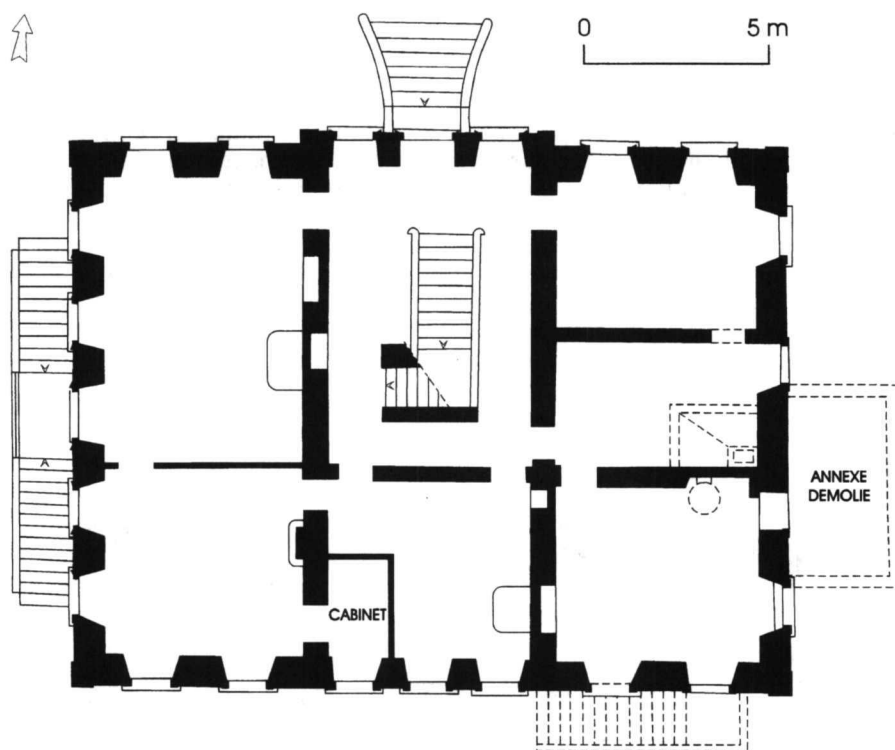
Sierre, Maison Pancrace de Courten. Plan du rez-de-chaussée. Reconstitution du plan d'origine avec circulation périphérique.
